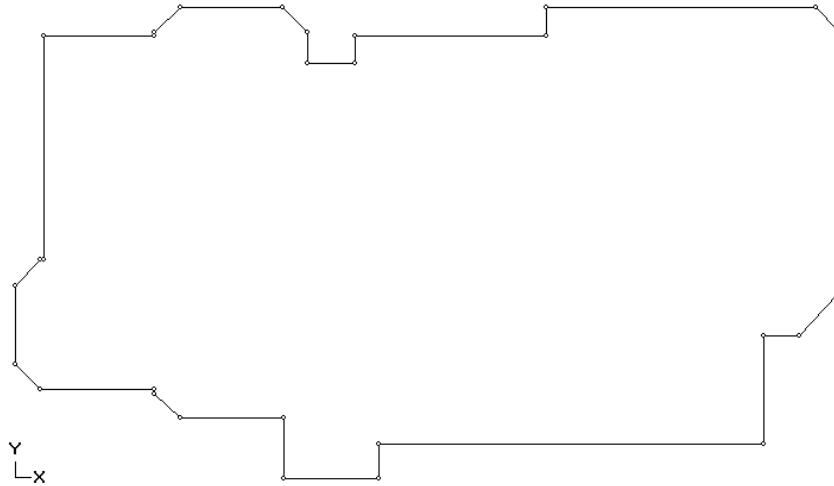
Опалубочне креслення фундаментної плити
